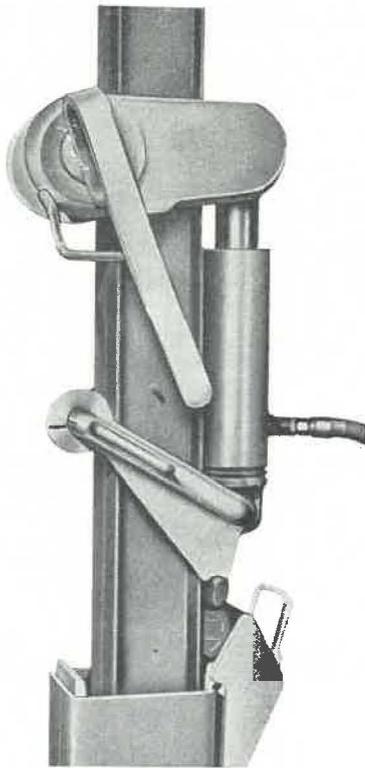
Extenseur hydraulique pour donner un préserage de 8 tonnes aux montants coulissants Usspurwies.
